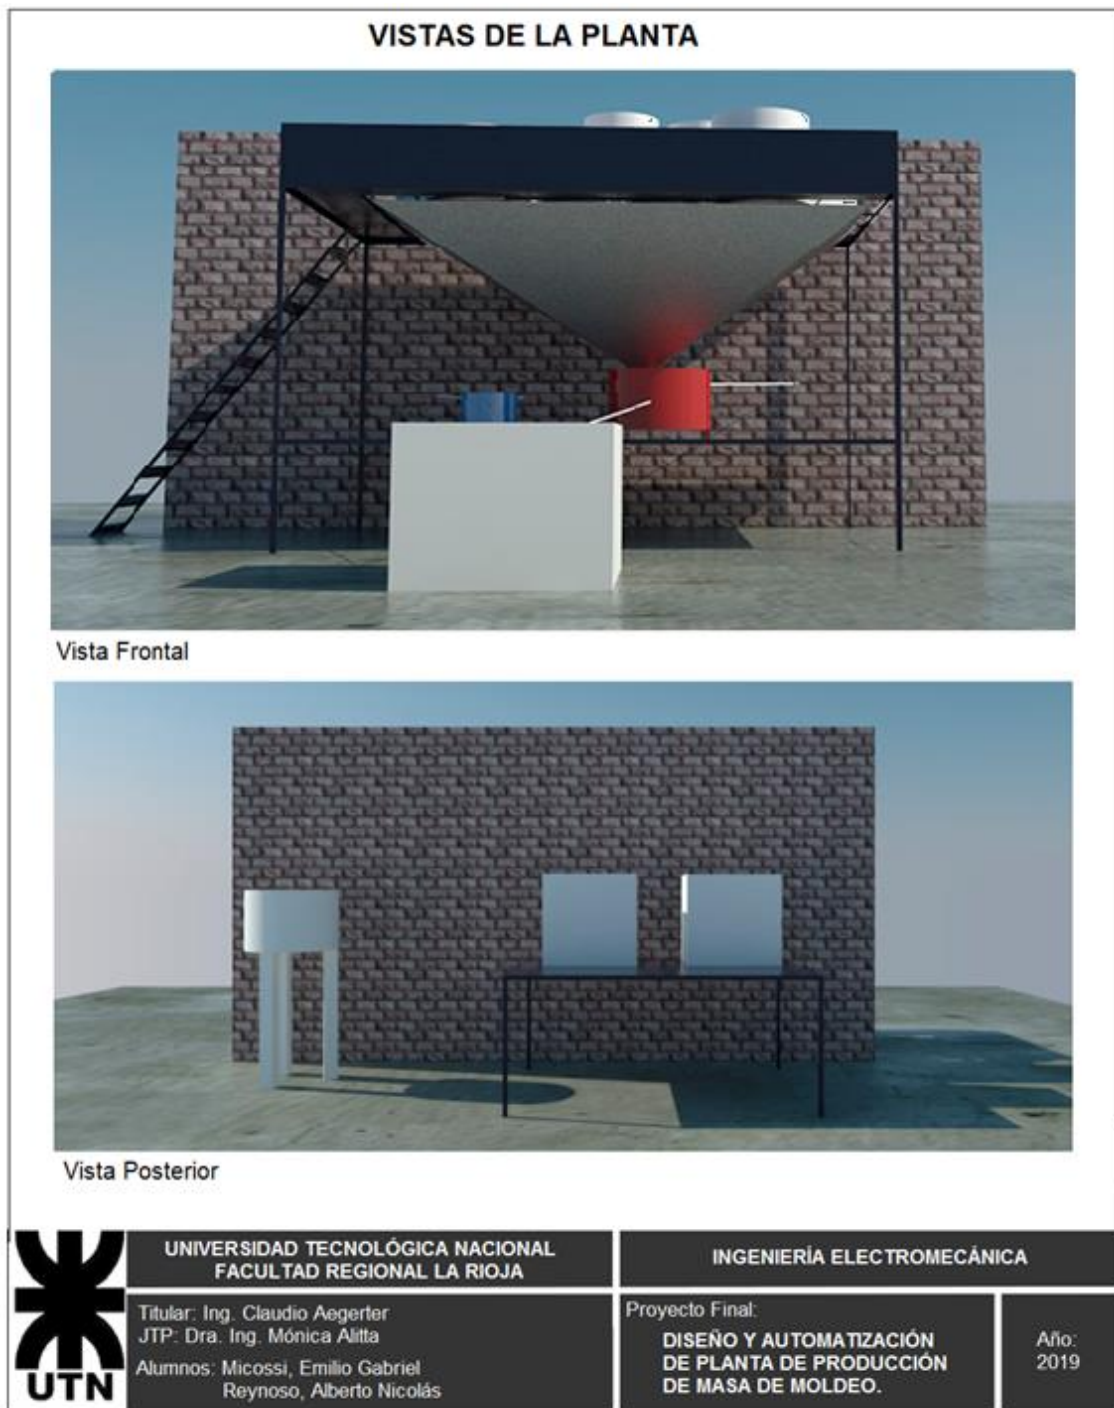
Plano de la planta con vistas frontal y posterior.
